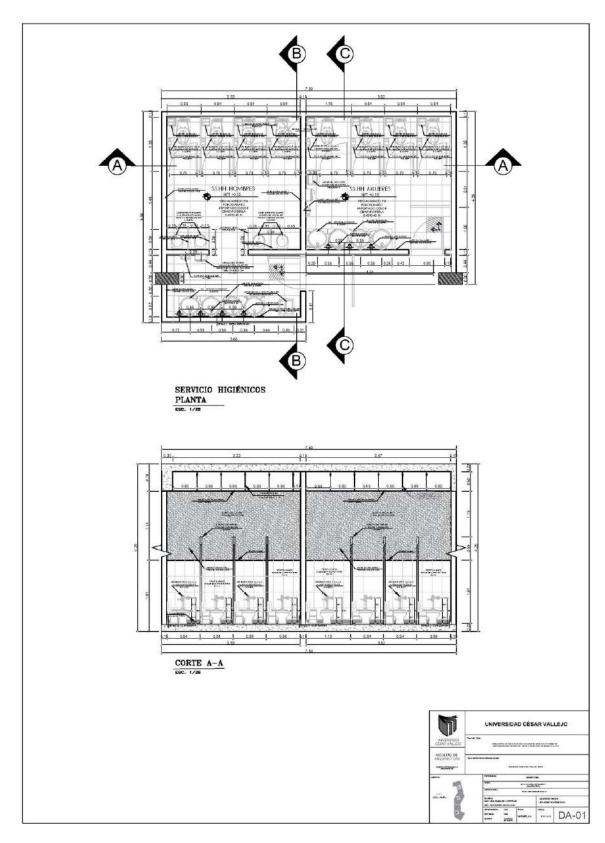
Detalle de baño - DETALLES ARQUITECTÓNICOS
